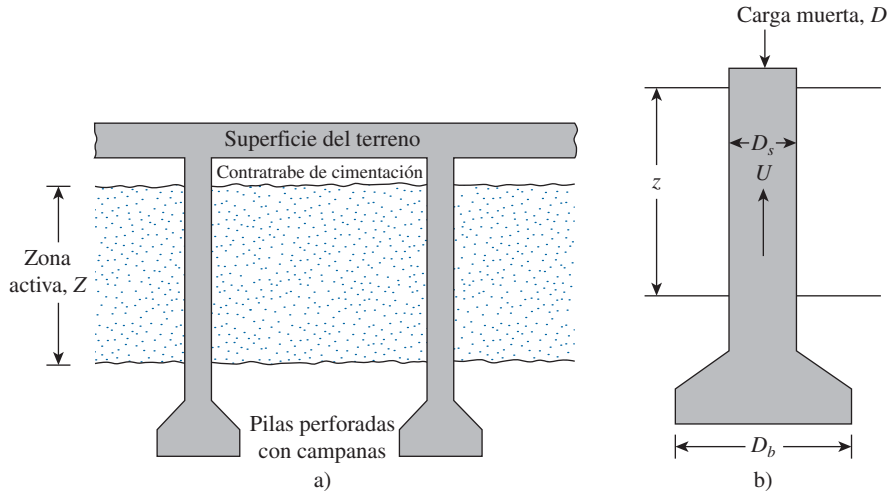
a) Construcción de pilas perforadas con campanas y contratraveses de cimentación; b) definición de los parámetros en la ecuación (13.14).
